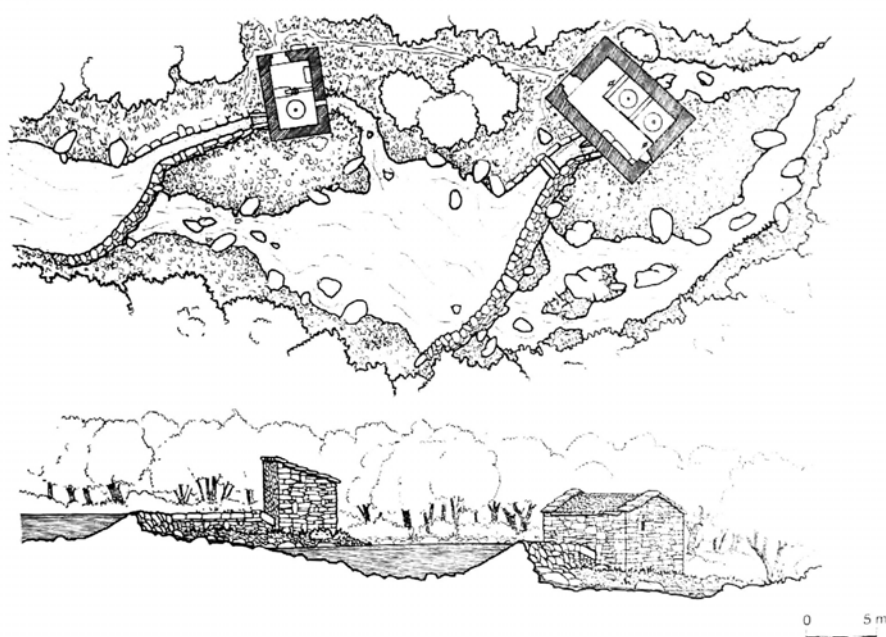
Ilustração em planta e alçado dos moinhos em Pontevedra.
